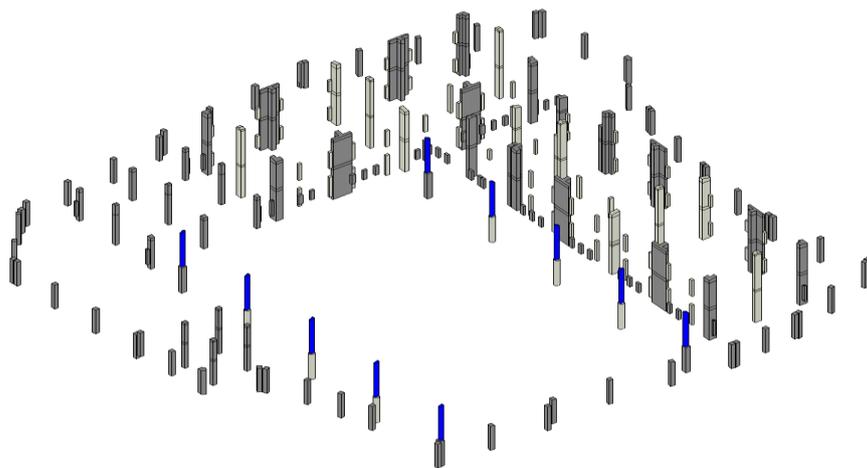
Categoría Pilares Estructurales aislada del modelo federado de Estructuras
